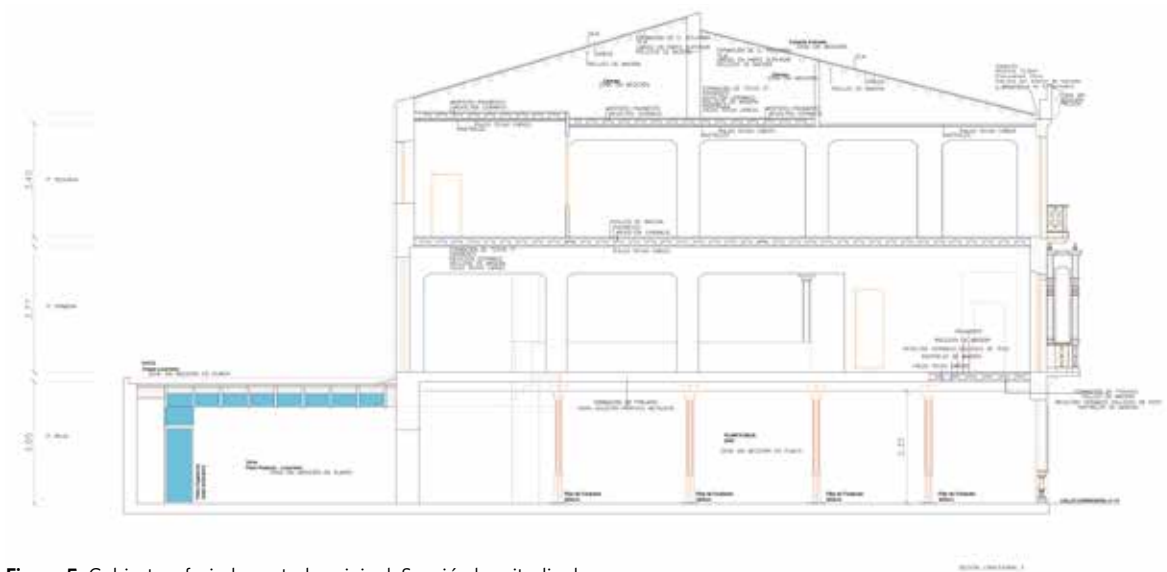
Cubierta y forjados estado original. Sección longitudinal.
